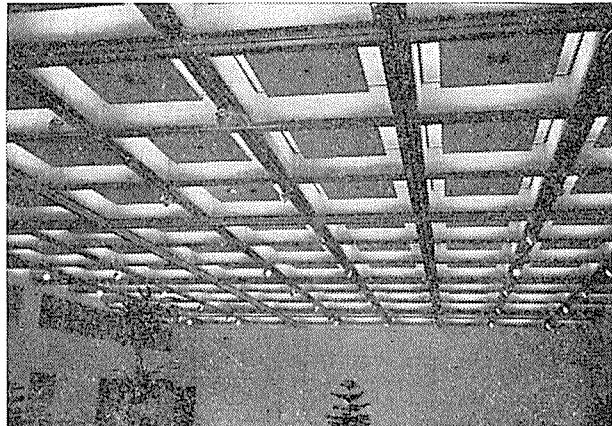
第 III 期工事のプレキャスト格子梁の完成状況
